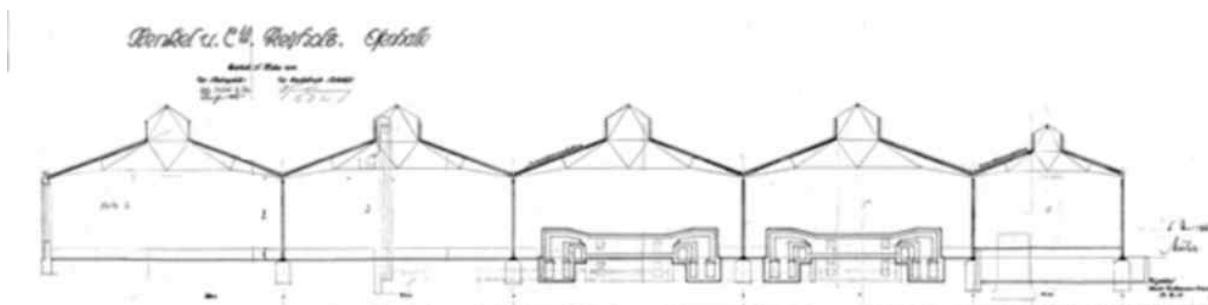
Neubau Wasserglasfabrik Geb. H 01, 1916 - Architekt: Walter Furthmann
